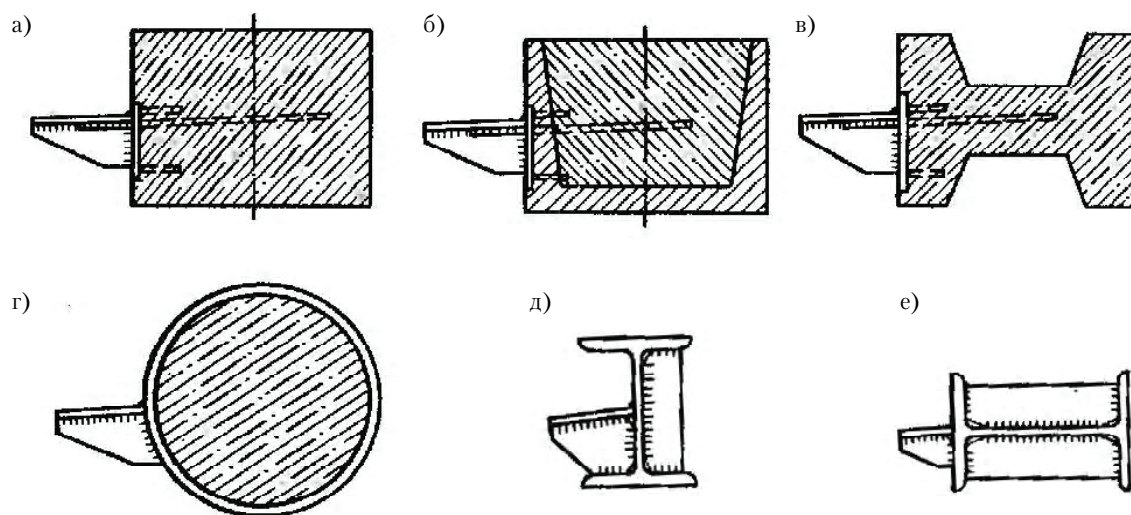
Форма поперечного сечения опорного контура мембран: а) сборный или монолитный элемент; б) сборно-монолитный элемент; в) двутавровый элемент; г) трубобетонный элемент; д) вертикальный двутавр; е) горизонтальный двутавр.
